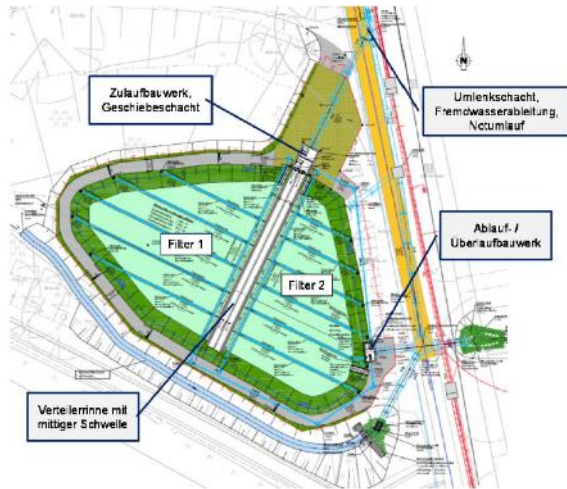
Lageplan Retentionsbodenfilteranlage Plettenberg
